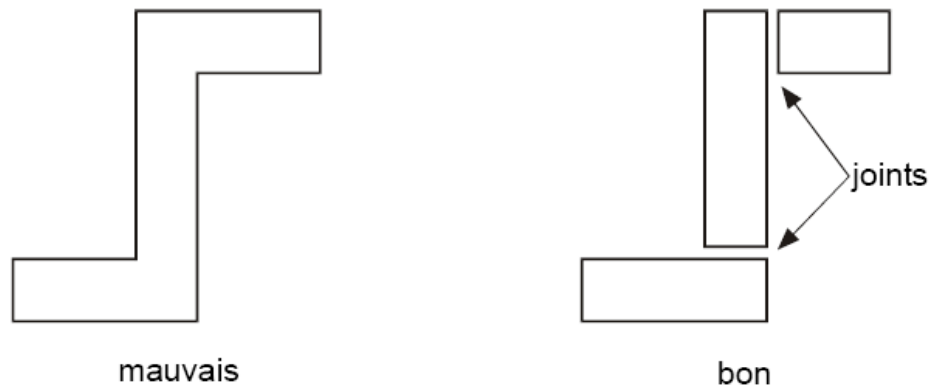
Fractionnement des bâtiments par des joints sismiques ou partition en sous structures.
